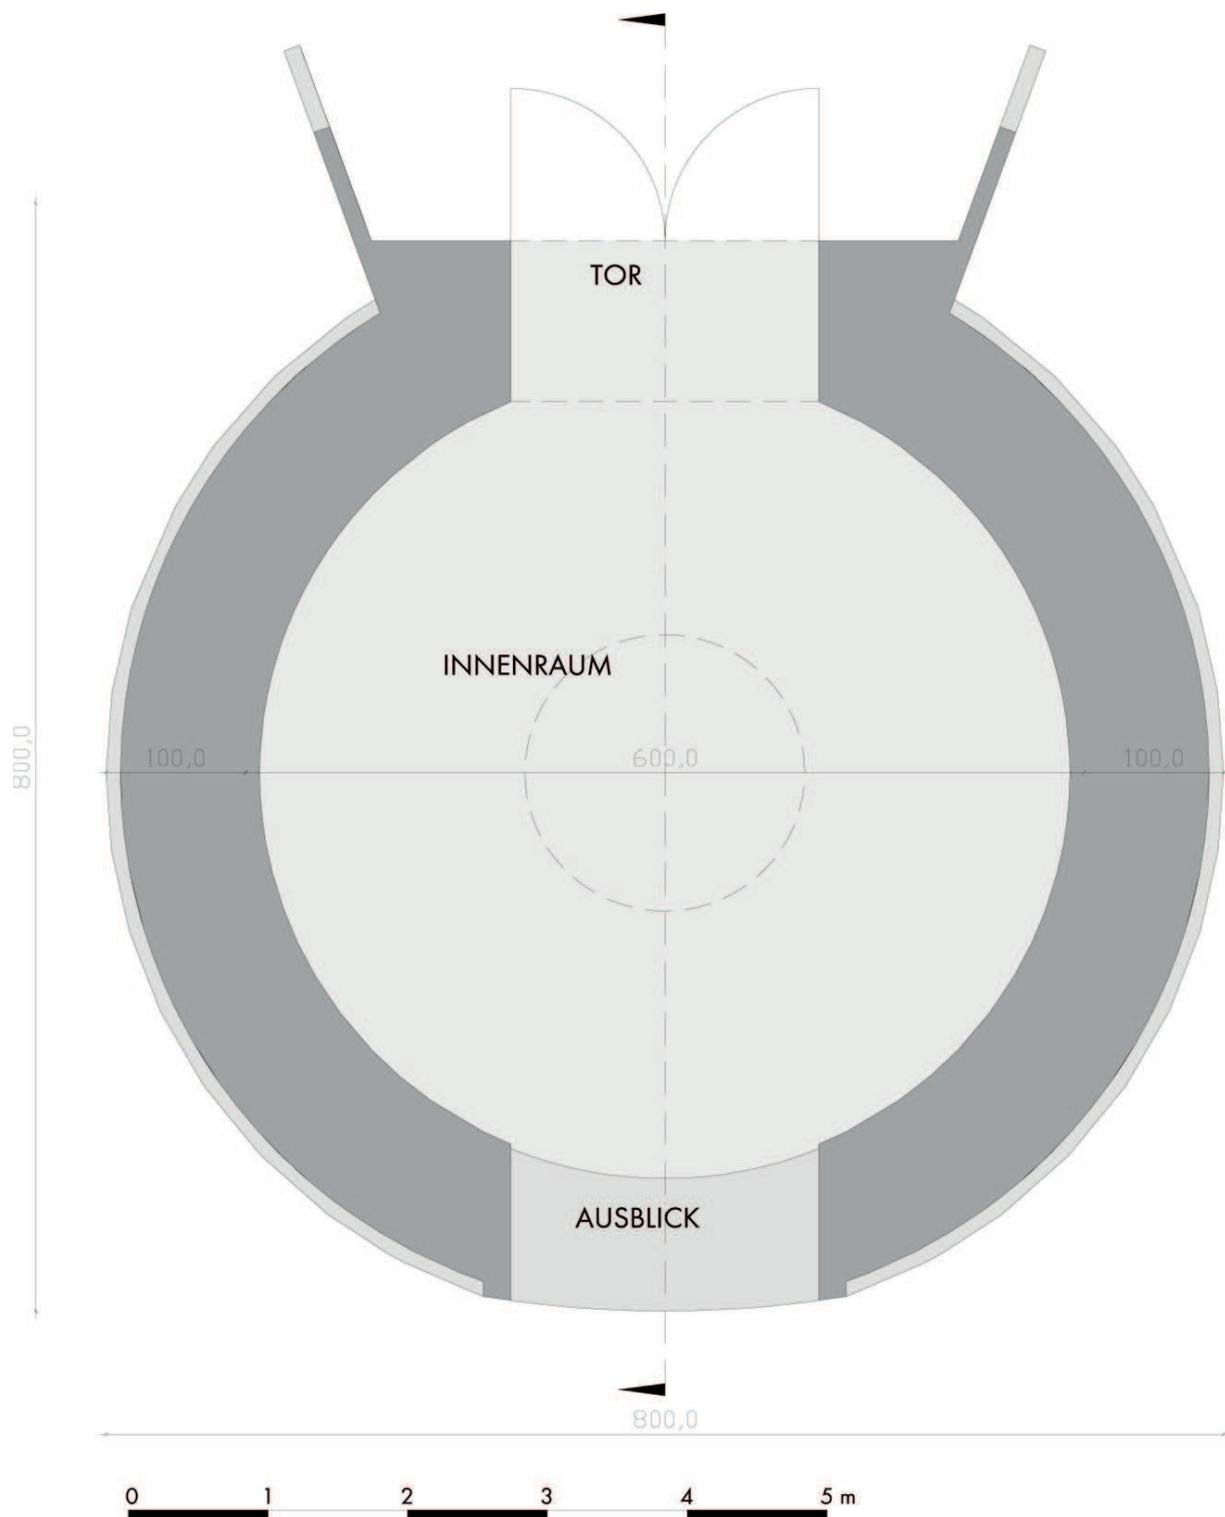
\_ Grundriss eines Bunkers (Maße entnommen von Stefa/Mydyti 2012, S. 38-39).
